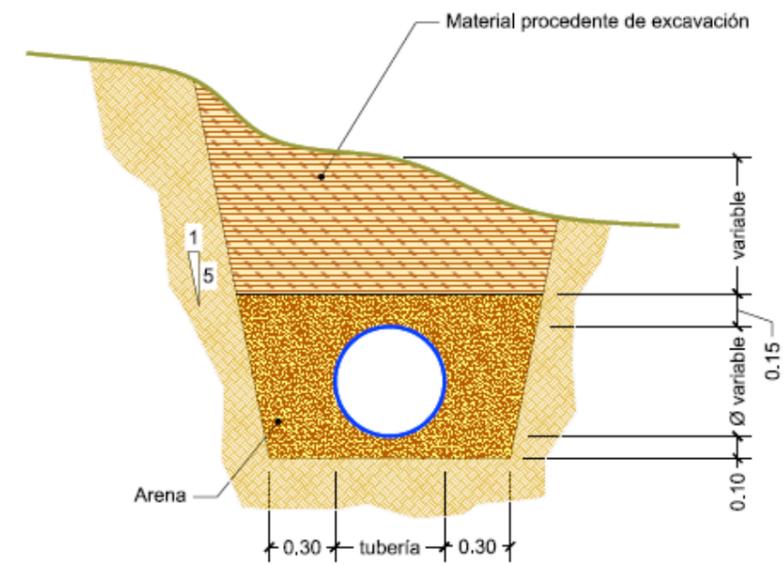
Secciones tipo – Zanja Conexión Saneamiento
